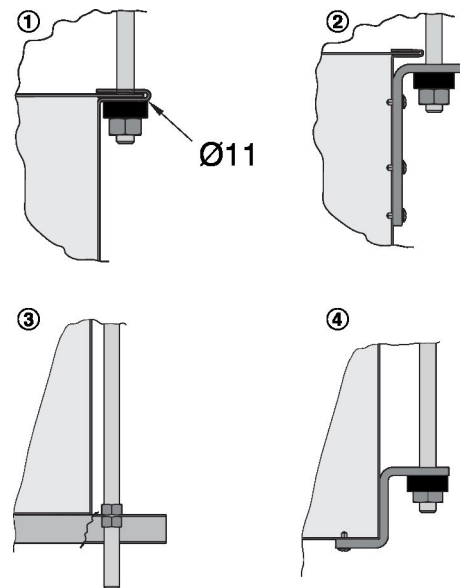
Befestigungsbeispiele rechteckige Geräte
